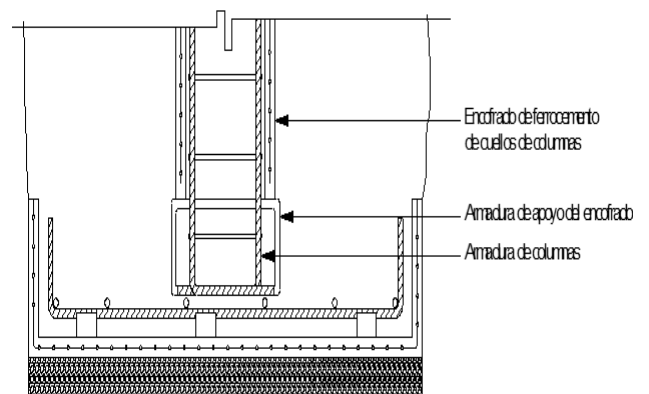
Apoyo de armadura de columna y encofrado de cuello de columna sobre armadura de zapata
